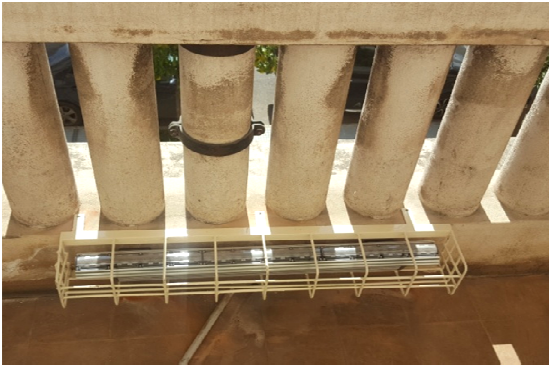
Protecciones anti vandálicas en luminarias ubicadas en los balcones tras las balaustradas.
